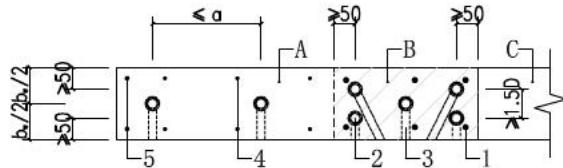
预制墙板内钢筋连接套筒布置示意
